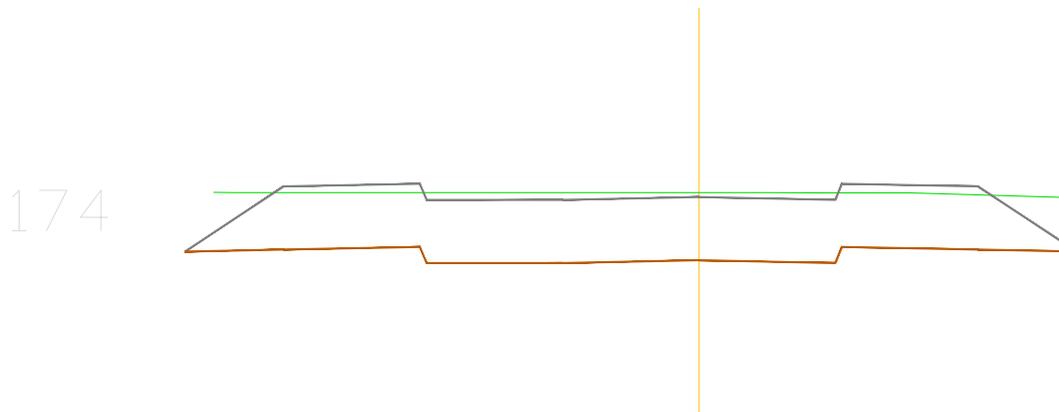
, Corte transversal del terreno modificado en el P.K. 0
